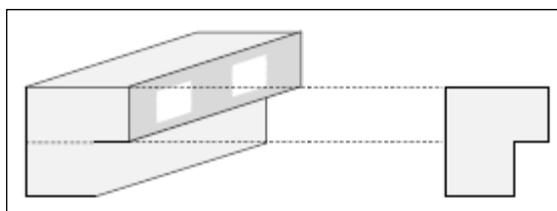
Parete perimetrale laterale con funzione di sostegno dello sbalzo.
